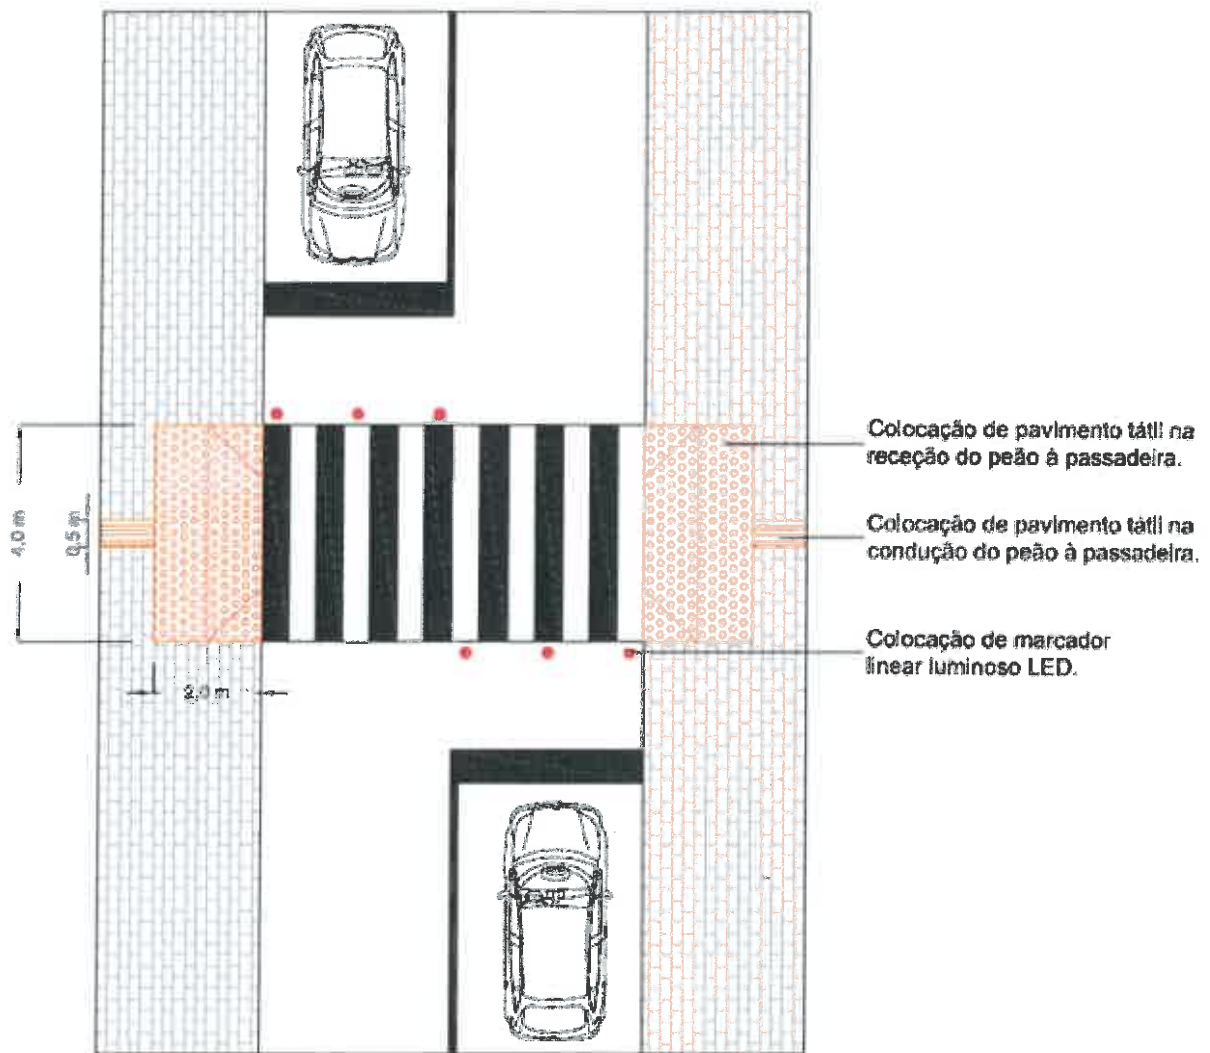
Esquema tipo com a indicação da colocação do pavimento tátil com piso direcional e piso de alerta. (Sem escala definida).
